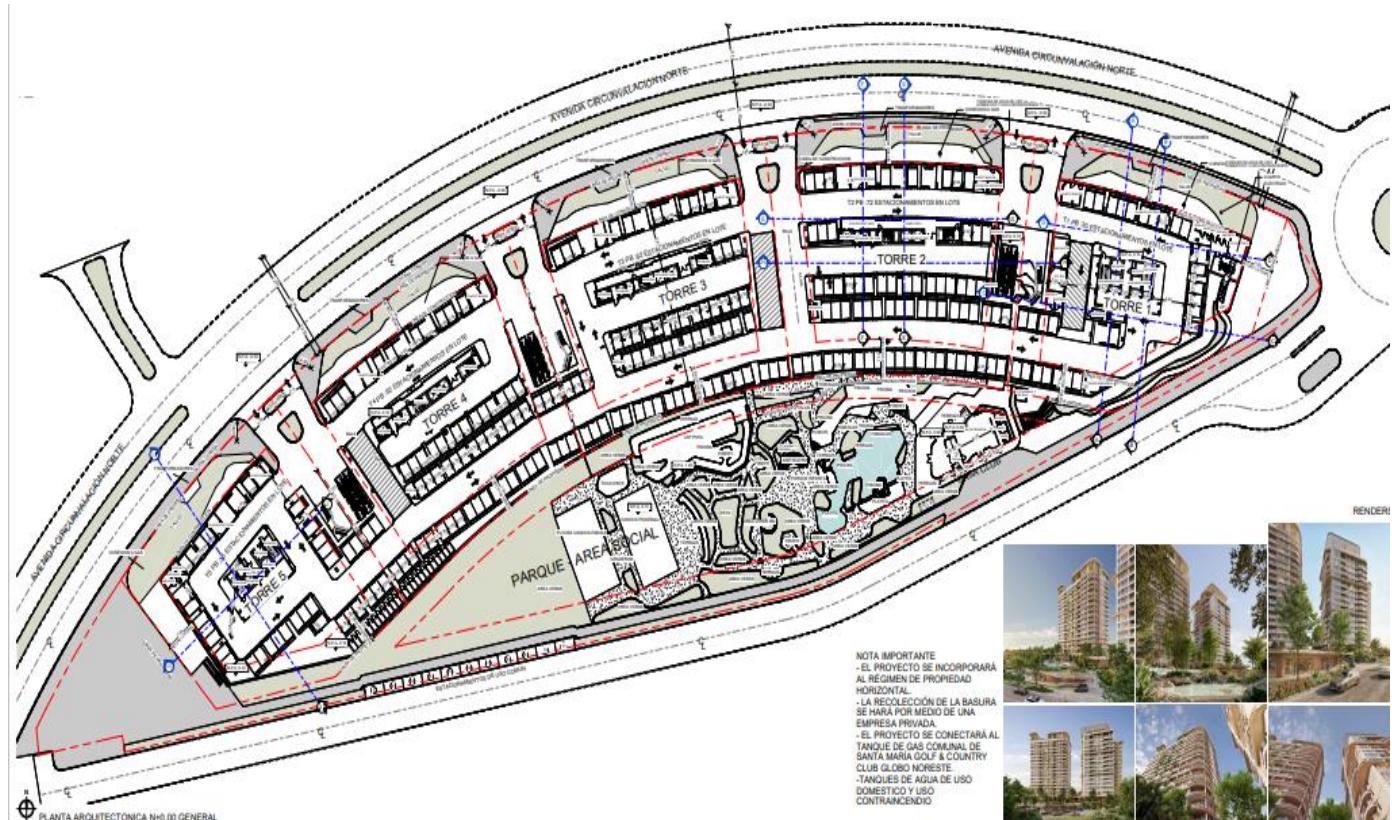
Fuente: Planos Arquitectónicos. Promotor
